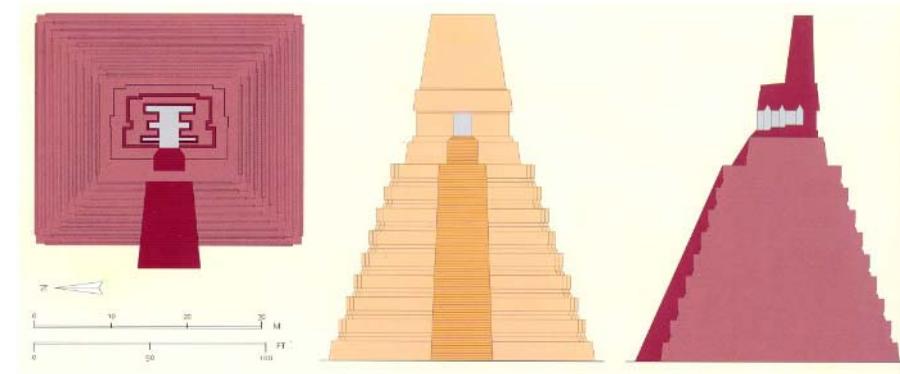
Planta Elevación y Sección del templo I de Tikal.
